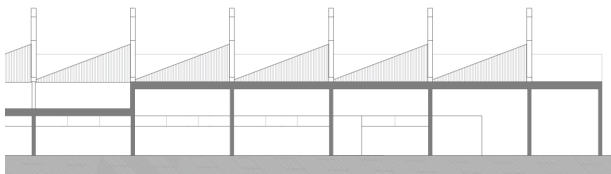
Alzado longitudinal de TABSA. Se marcan los pórticos de la estructura, que quedan vistos en la fachada.
